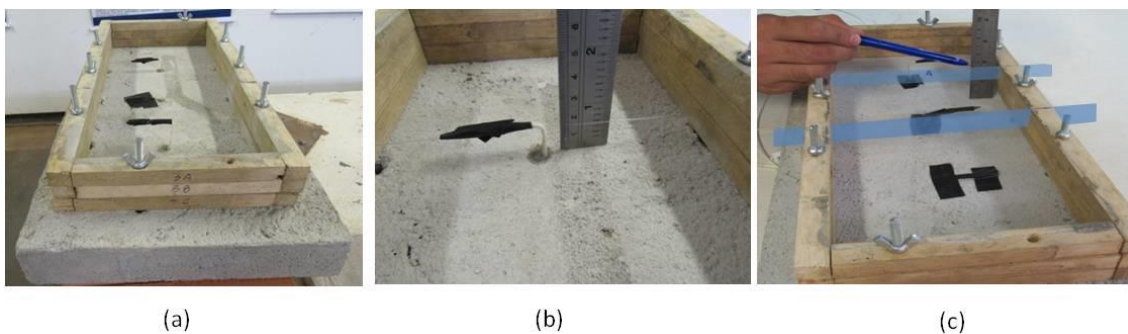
(a) Moldagem da camada de argamassa; (b) Condição da camada após o acabamento na moldagem; (c) Aspecto final das fissuras de estudo no corpo de prova
